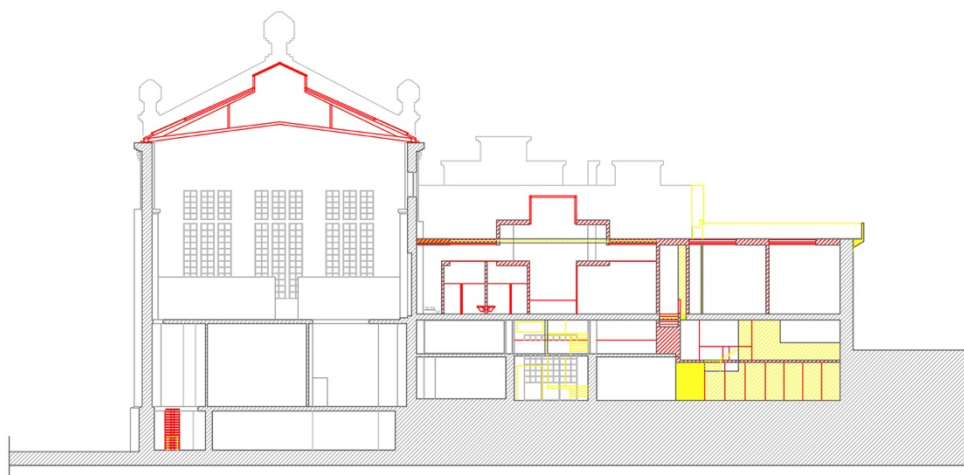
Sobreposição dos elementos a construir e a demolir, corte h;
